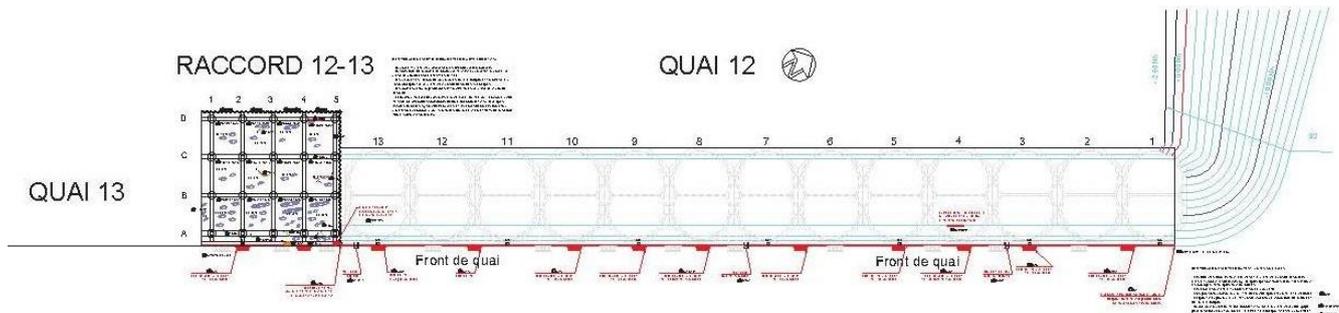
Plan du quai 12 dans sa configuration actuelle
